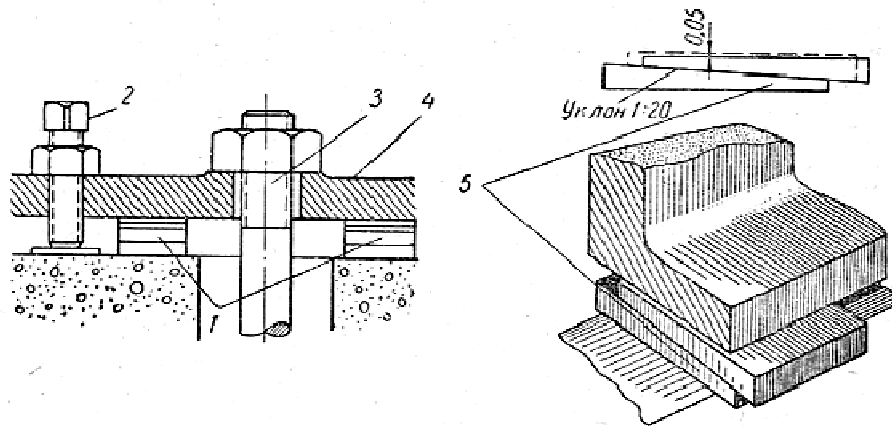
Приспособления для выверки оборудования на фундаментах:
